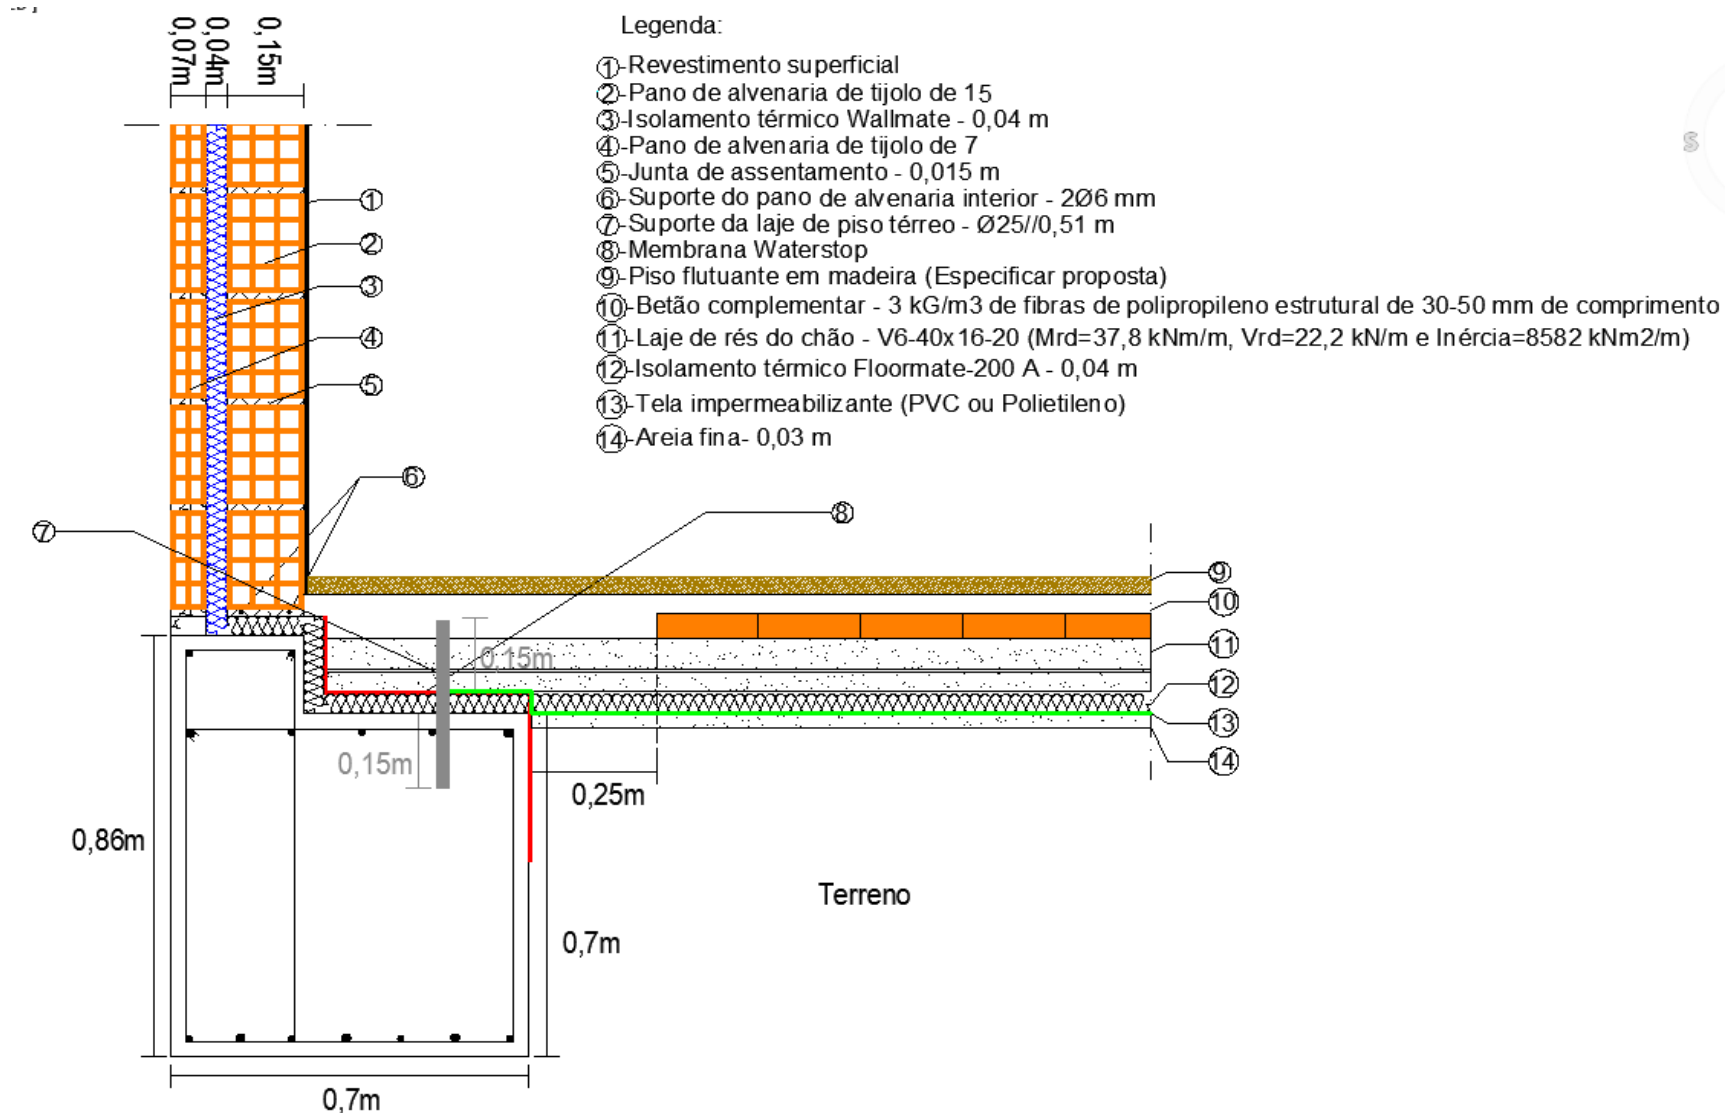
Pormenor da ligação à viga de fundação do pórtico 1-1'
